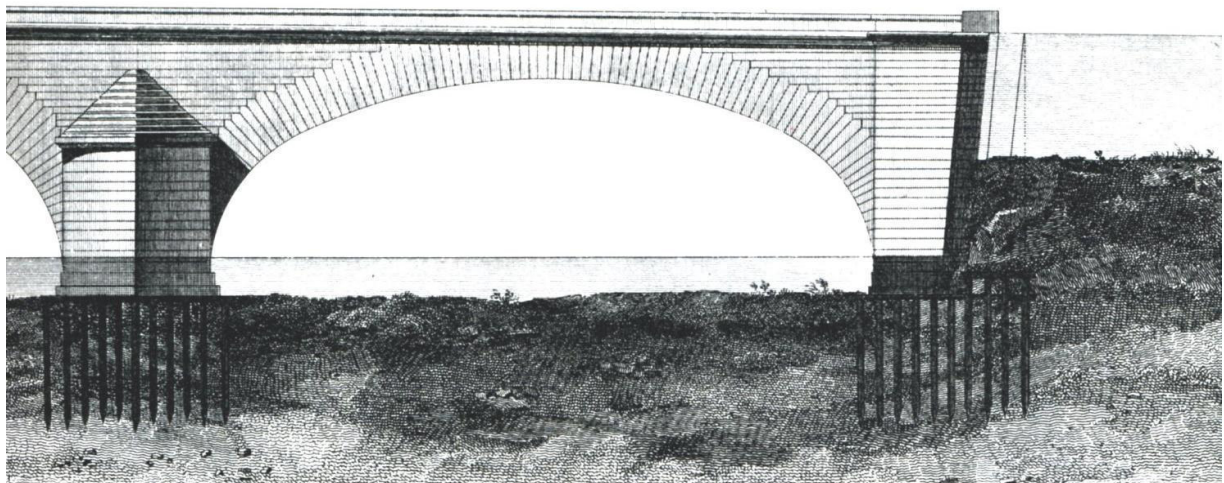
Alzado de un arco del puente de Mantes construido por Perronet en 1756
